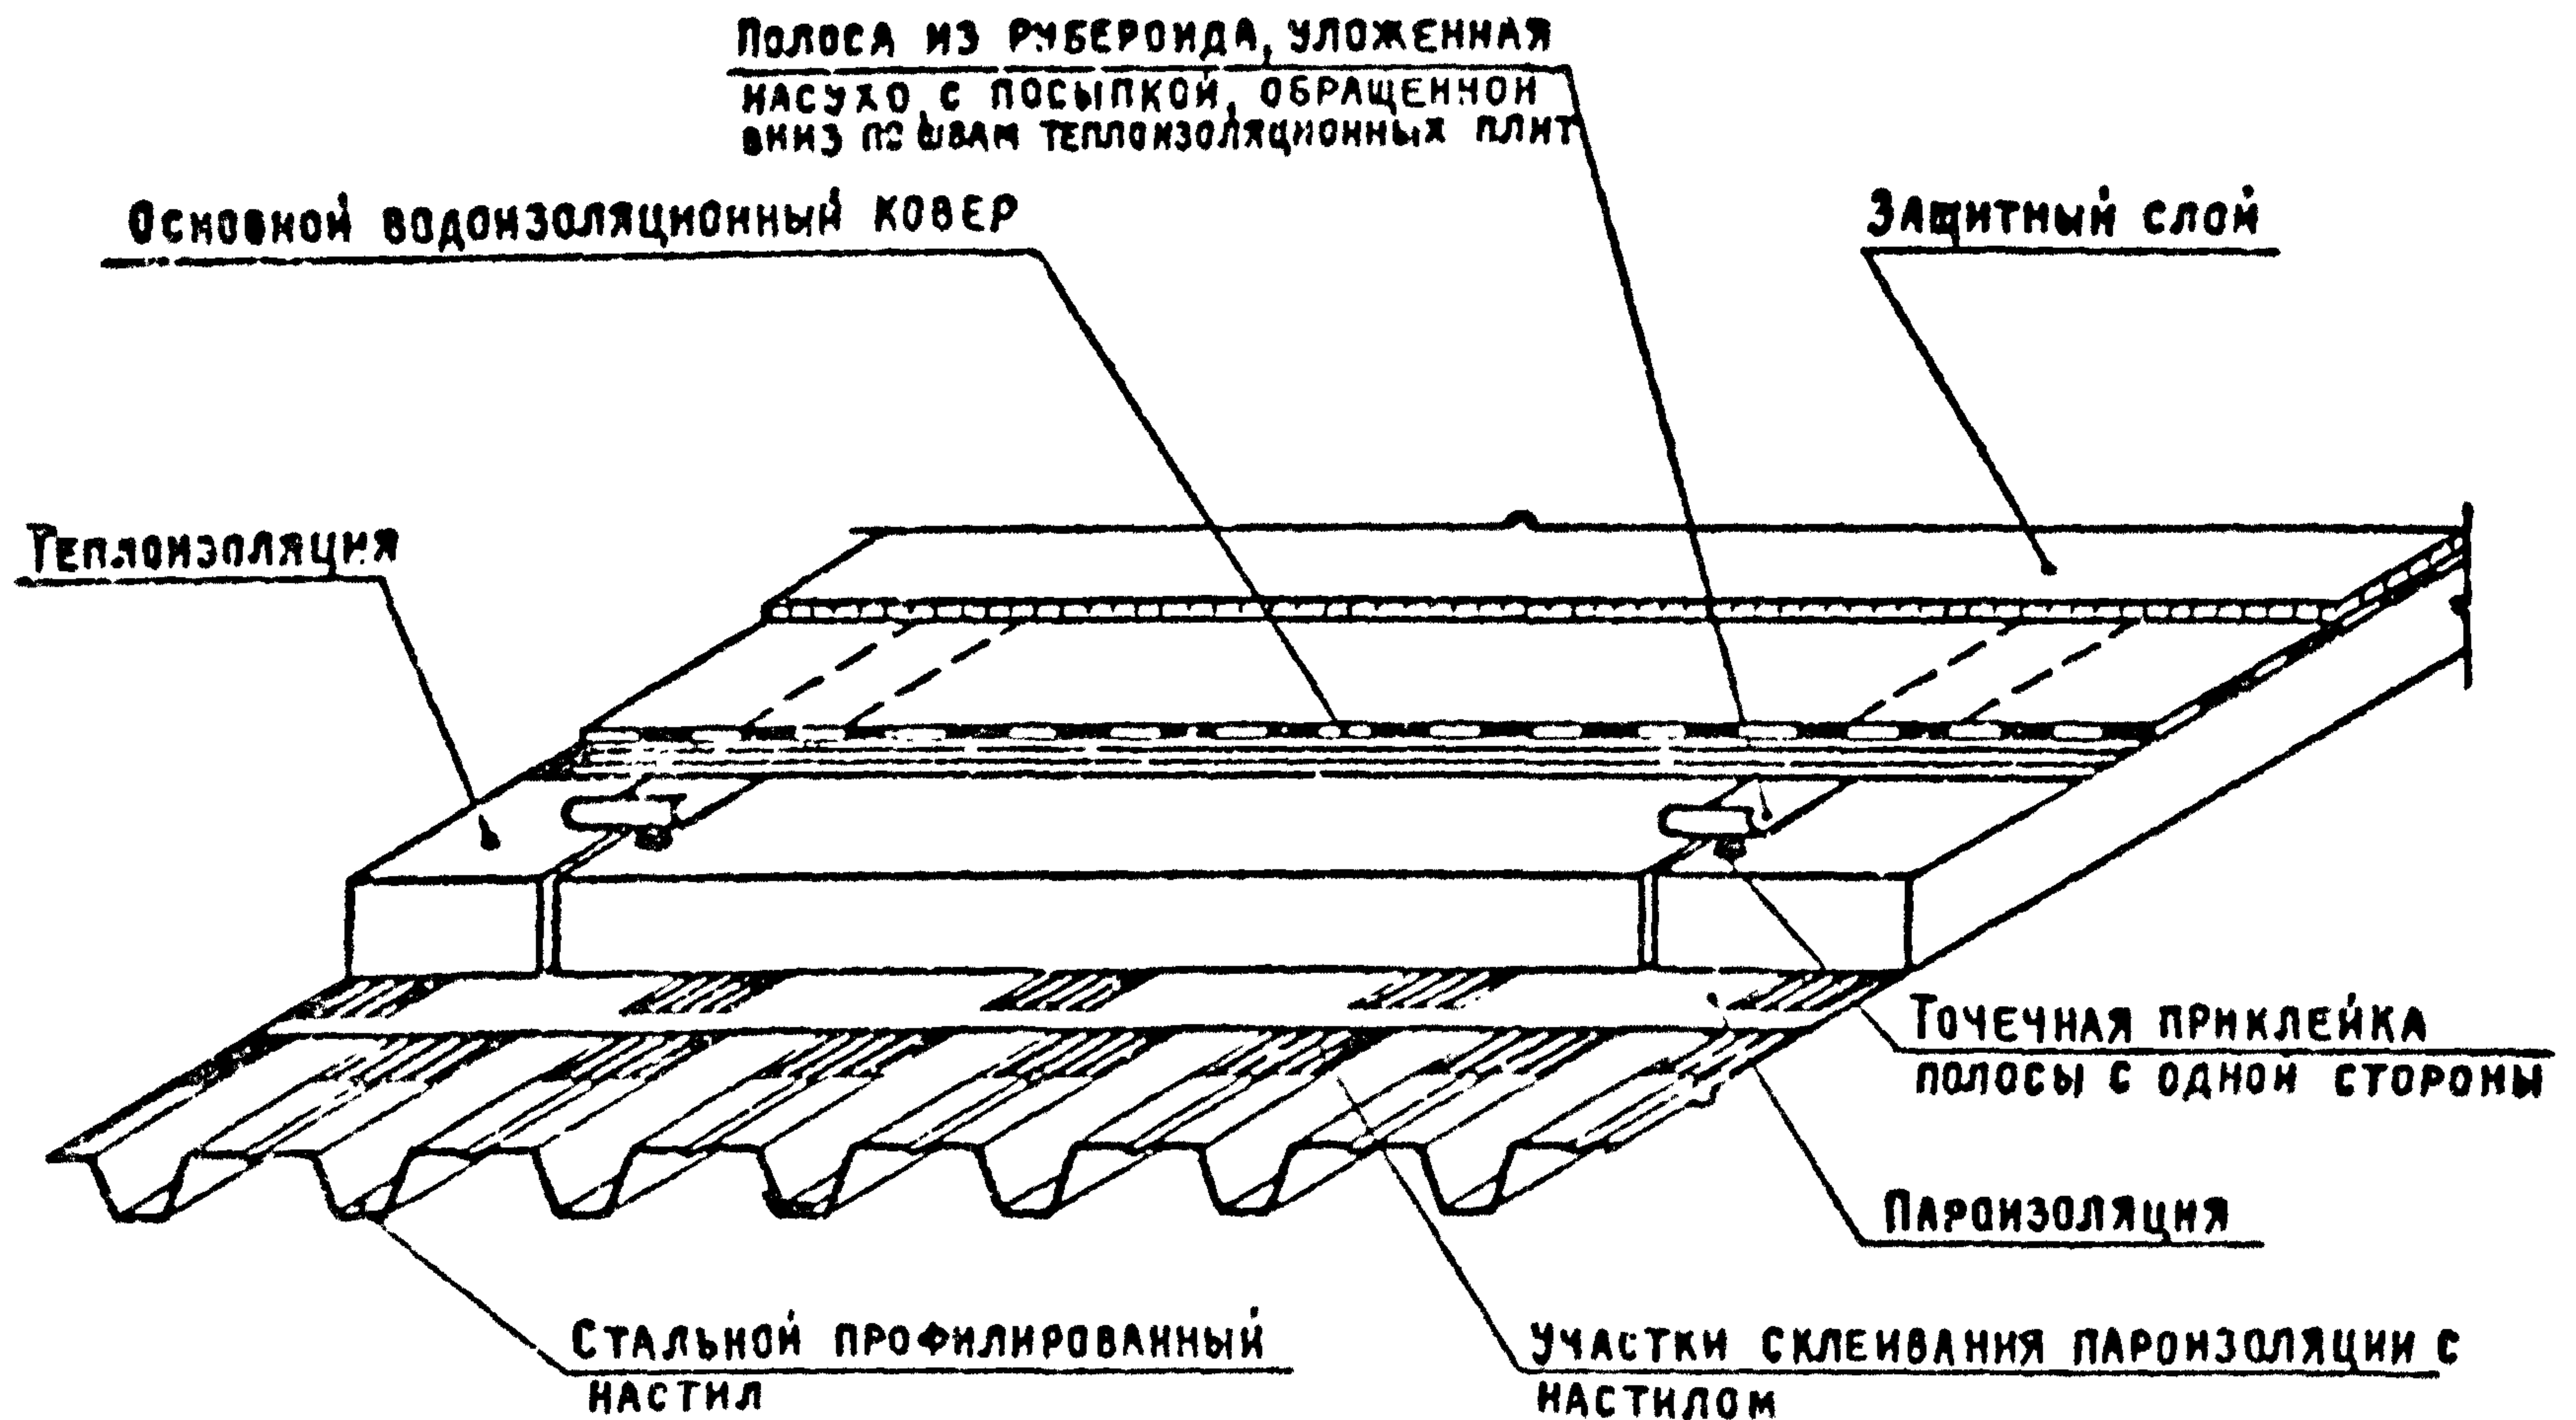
Для покрытий с теплоизоляцией — основанием под кровлю
